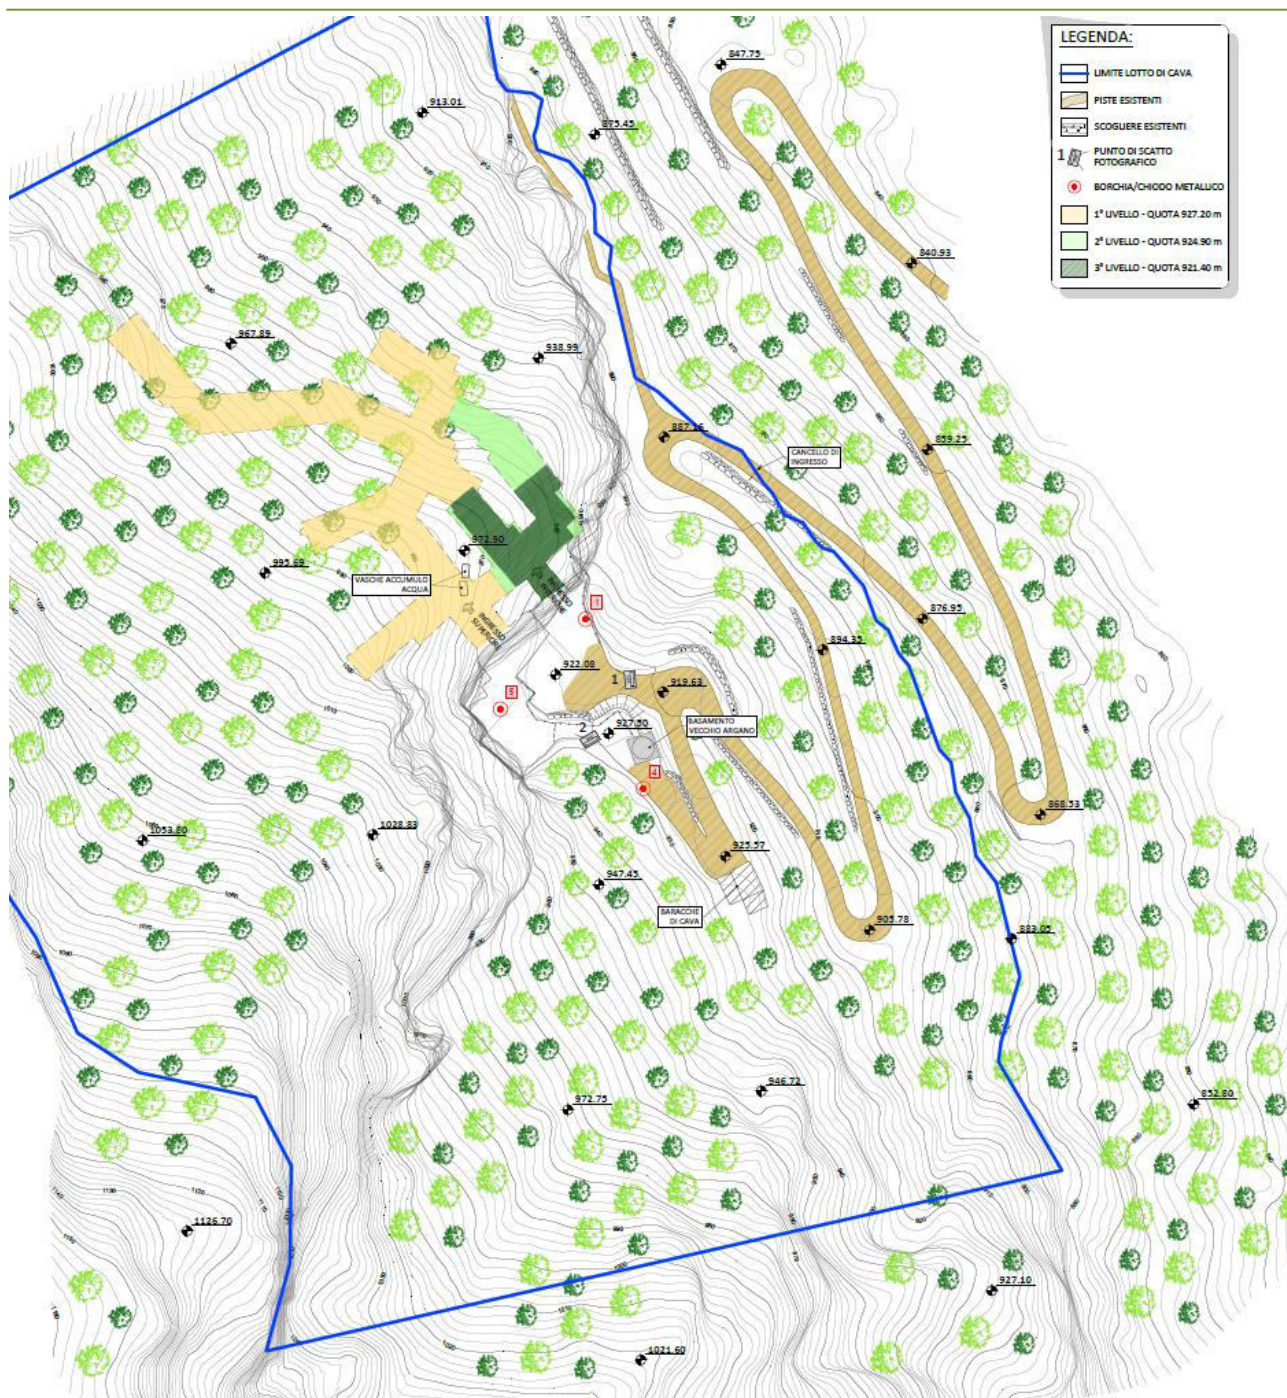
Stralcio di planimetria di rilievo delle aree esterne.
